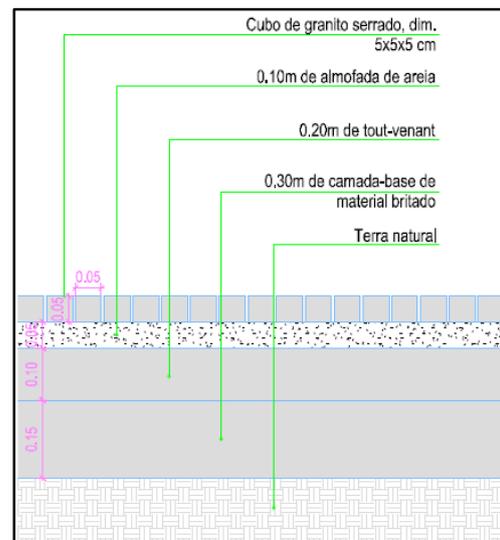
Pavimento das zonas de intenso tráfego pedonal
